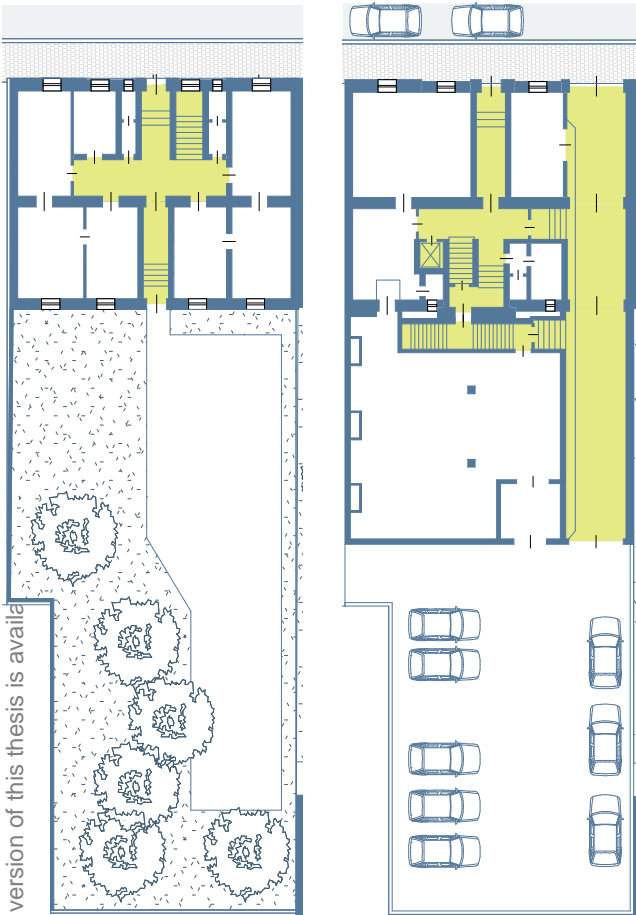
Grundriss eines Gründerzeitgebäudes mit nachträglich erhaltener Hofdurchfahrt und gewerblicher Nutzung des Hofes
